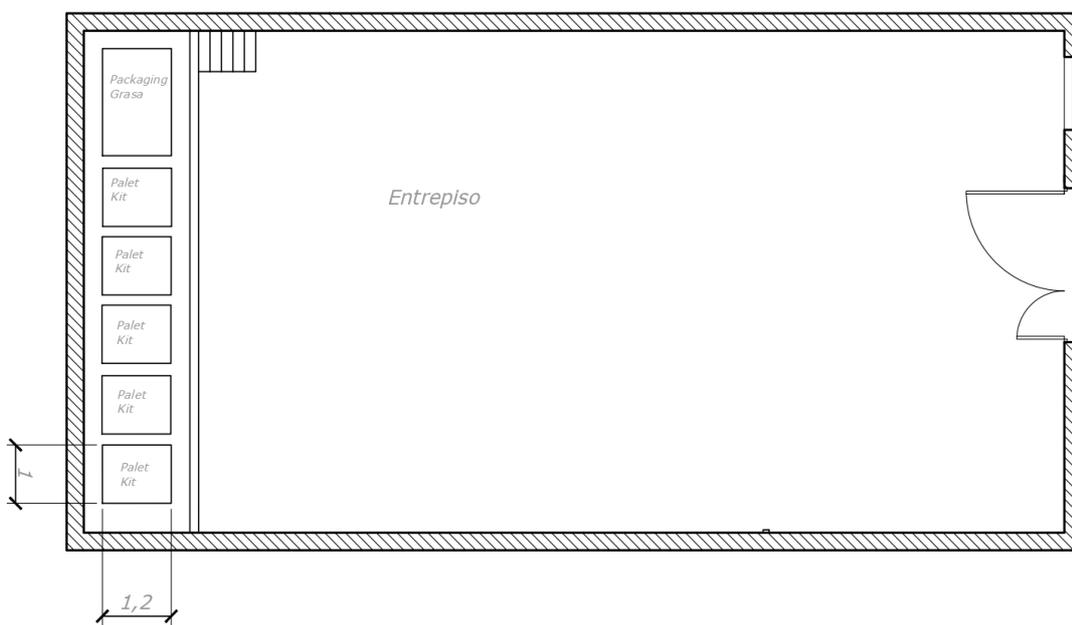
Plano instalaciones entrepiso - Fuente: Elaboración propia
